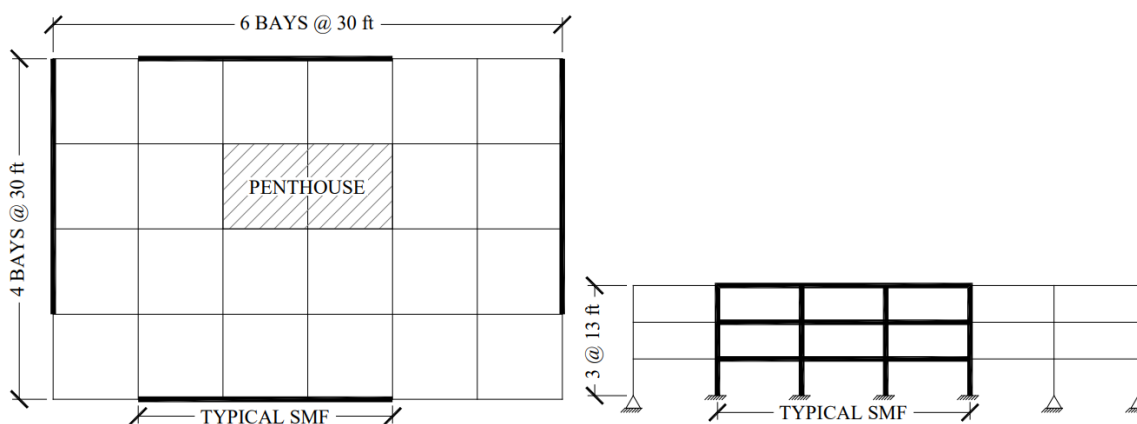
Vista en planta y transversal del edificio de 3 pisos en estudio (Wood 2012).
